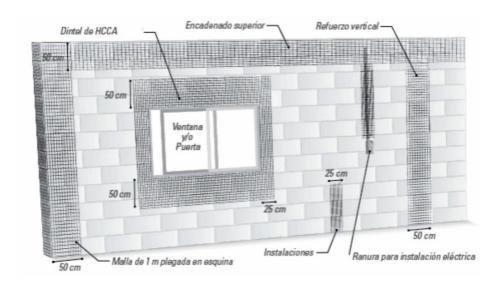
Colocación de malla de fibra de vidrio en mampostería de hormigón celular. Fuente: Manual constructivo de ladrillo de marca reconocida.
